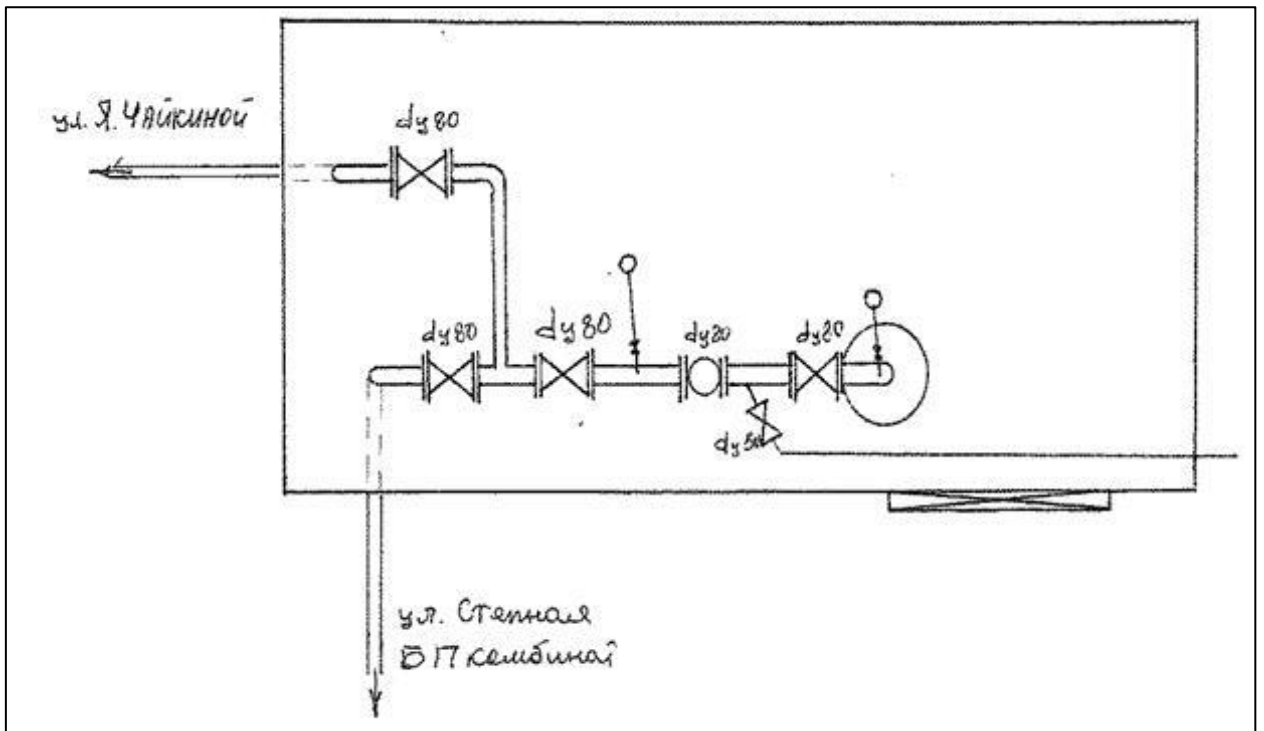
Схема напорного трубопровода и ЗРА водозаборной скважины № К-2164
